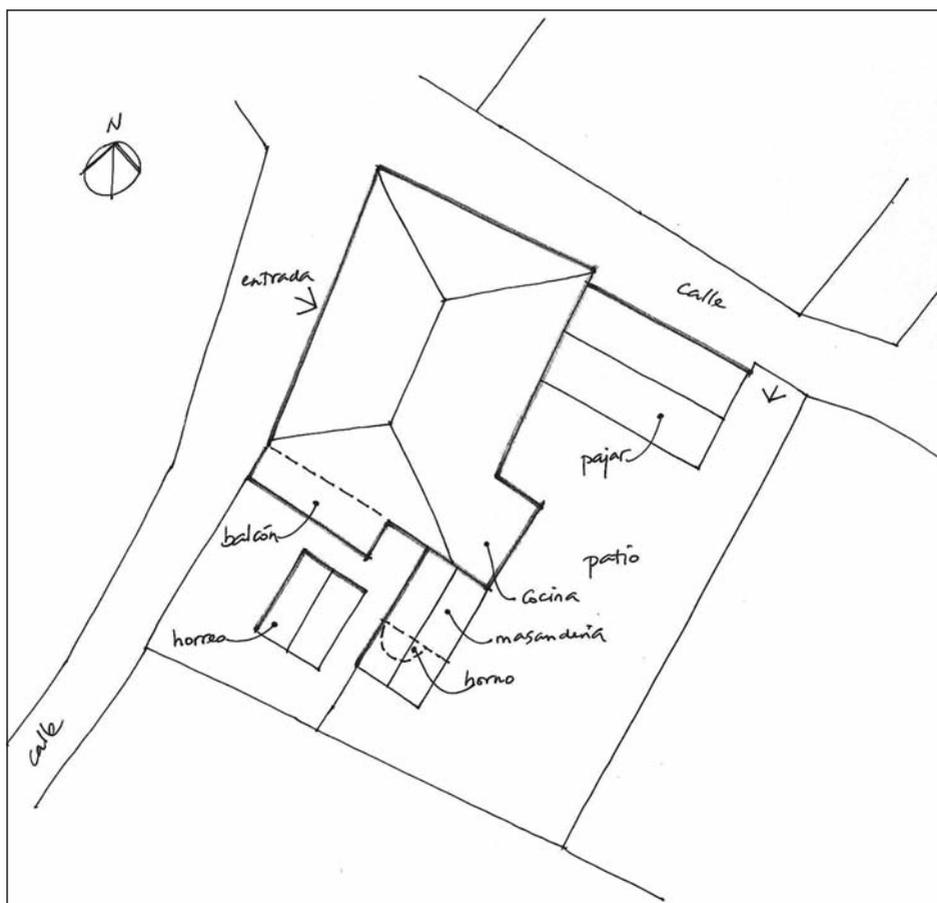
Casa Ballaz: distribución en planta del conjunto de las dependencias. (Dibujo: R. Urtasun).
